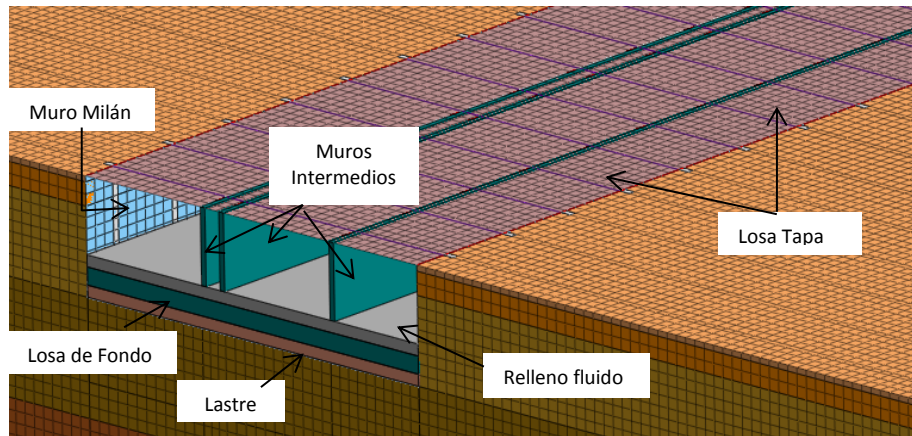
Construcción de Losa Tapa - 3D.
